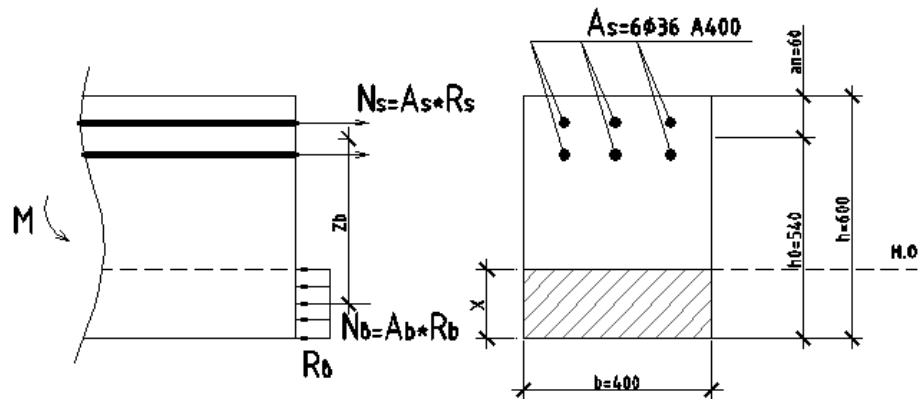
Схема внутренних усилий главной балки над на опоре
